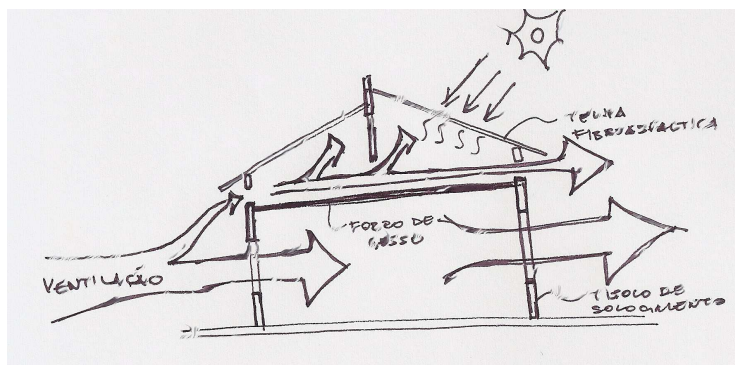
Croqui de estudo da ação da ventilação predominante sobre o telhado
